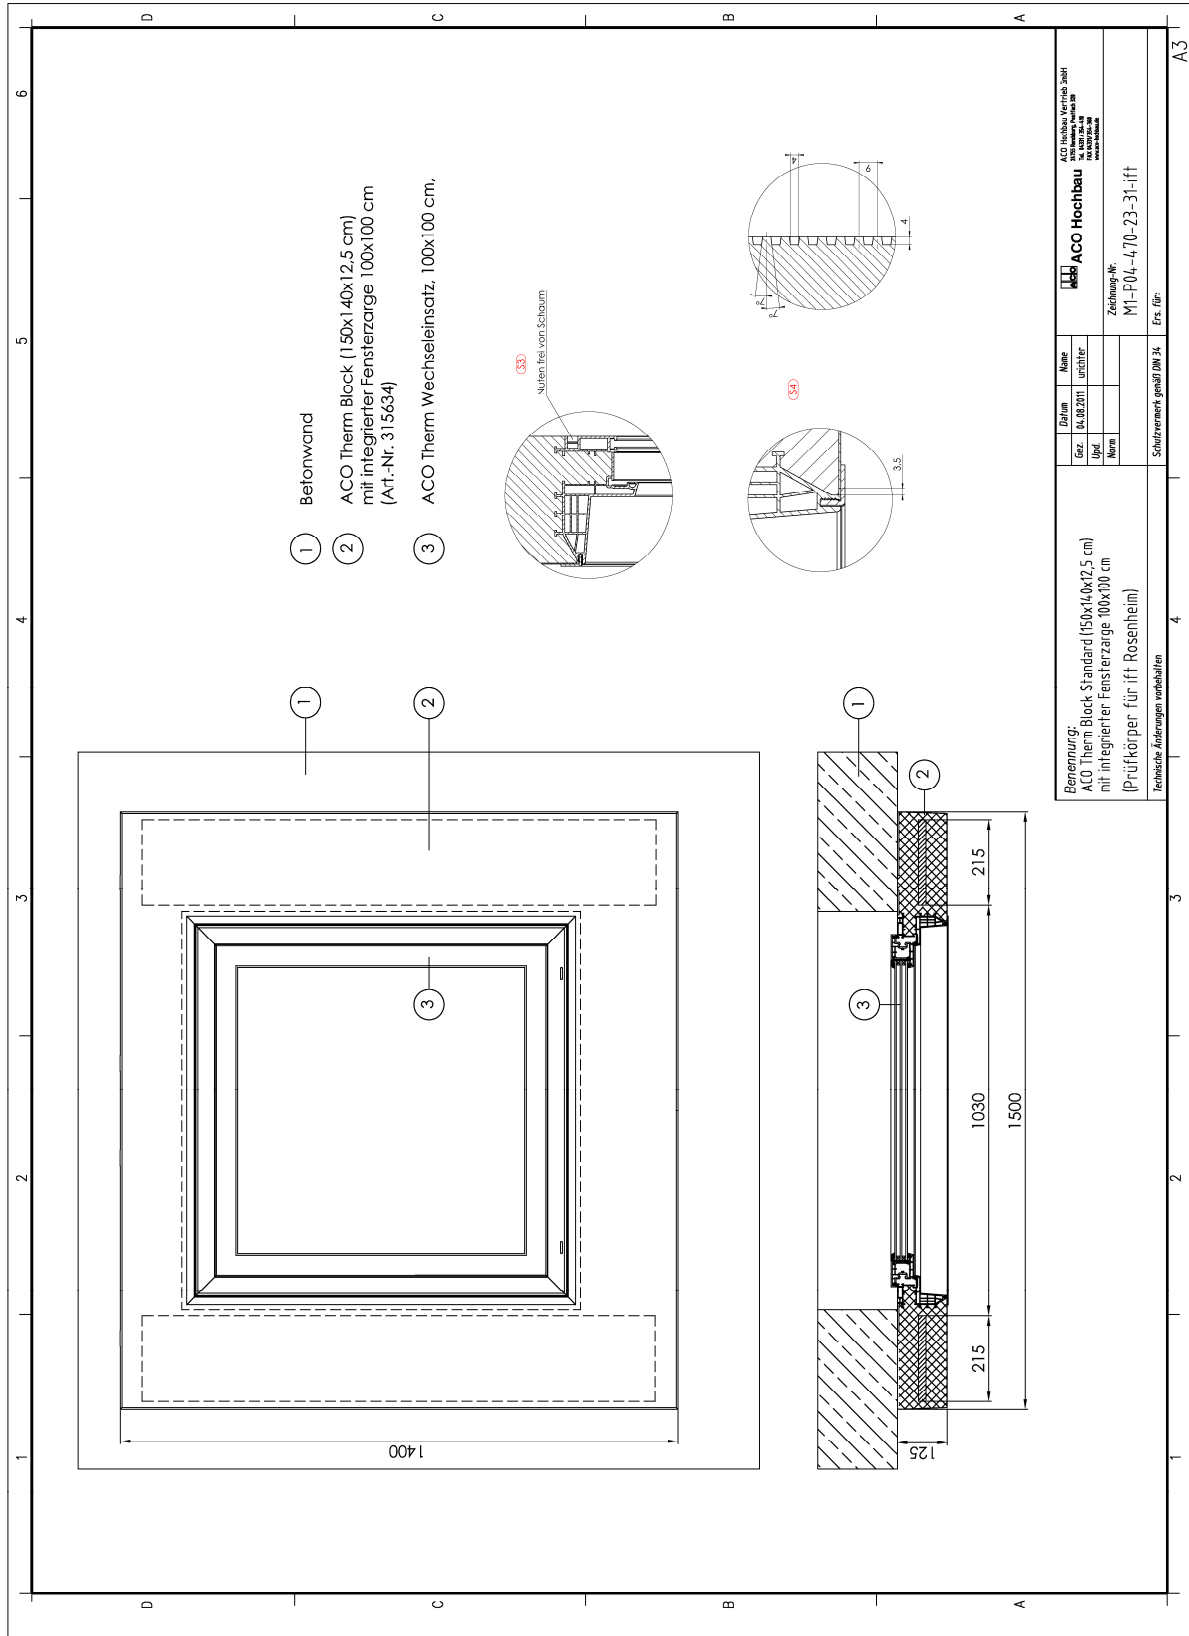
Probekörperdarstellung Betongrundkörper mit aufgeklebter Dämmplatte mit integriertem Fenster.
